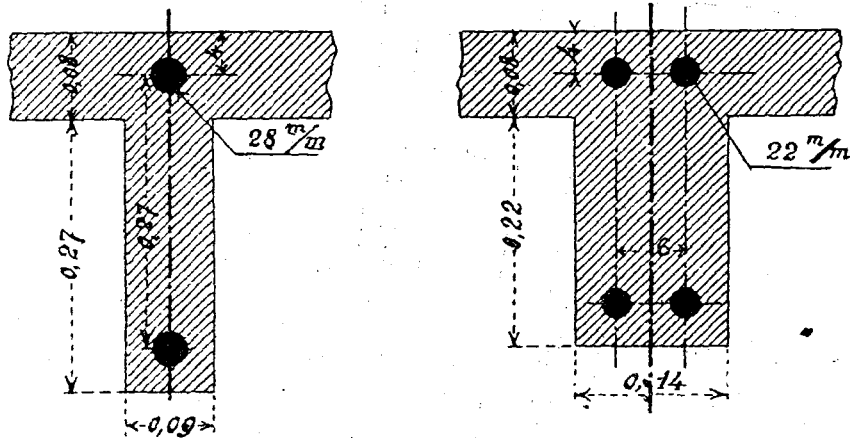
Construcción monolítica de hormigón armado, sistema Hennebique.
